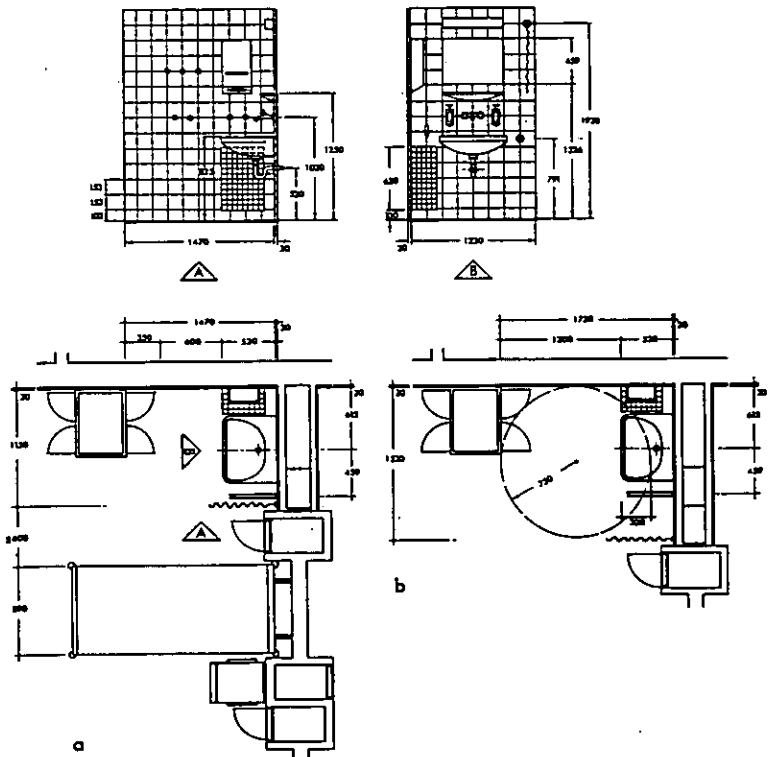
Waschplatz-Bemessung bei Ausstattung mit Papierhandtuchspender, Papierkorb und Handtuchhalter
